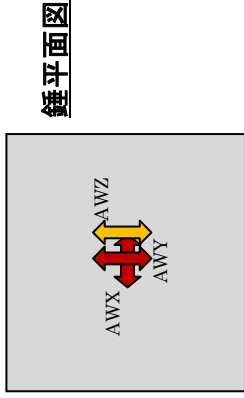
(1) センサー配置図 (断面図) 仕様 1 (1/4)
